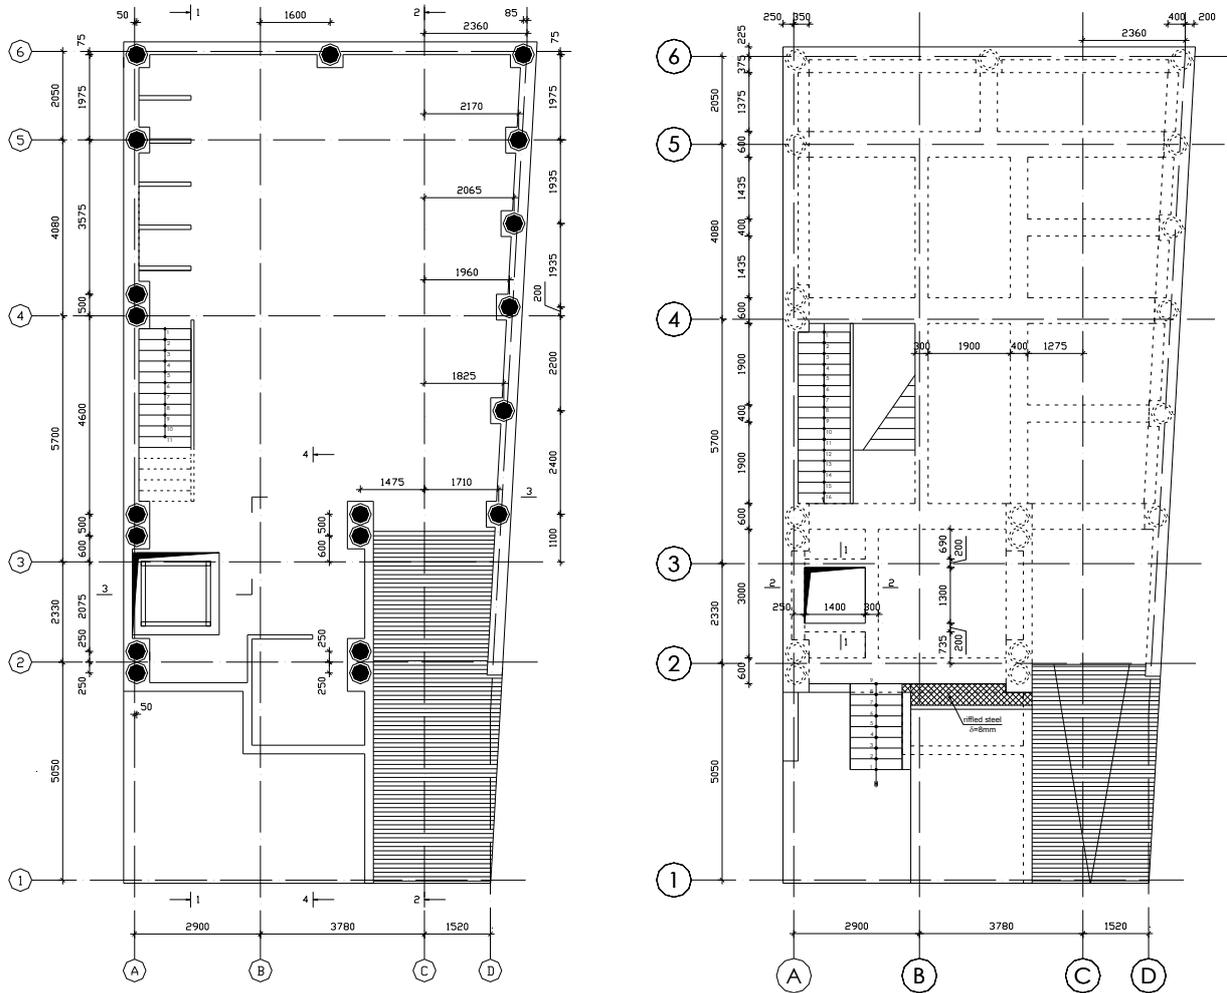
План расположения сейсмоизоляторов в подвальном этаже и план перекрытия над системой сейсмоизоляции жилого здания по ул. Чулло в г. Арекипа
